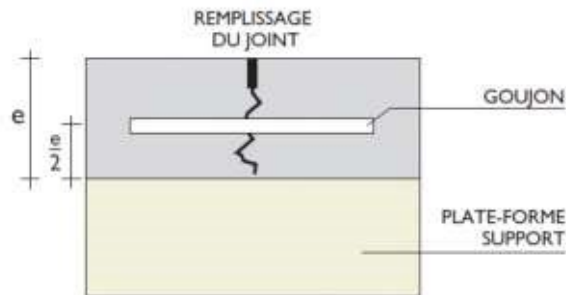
Schéma d'un joint de construction (source : CimBéton).
